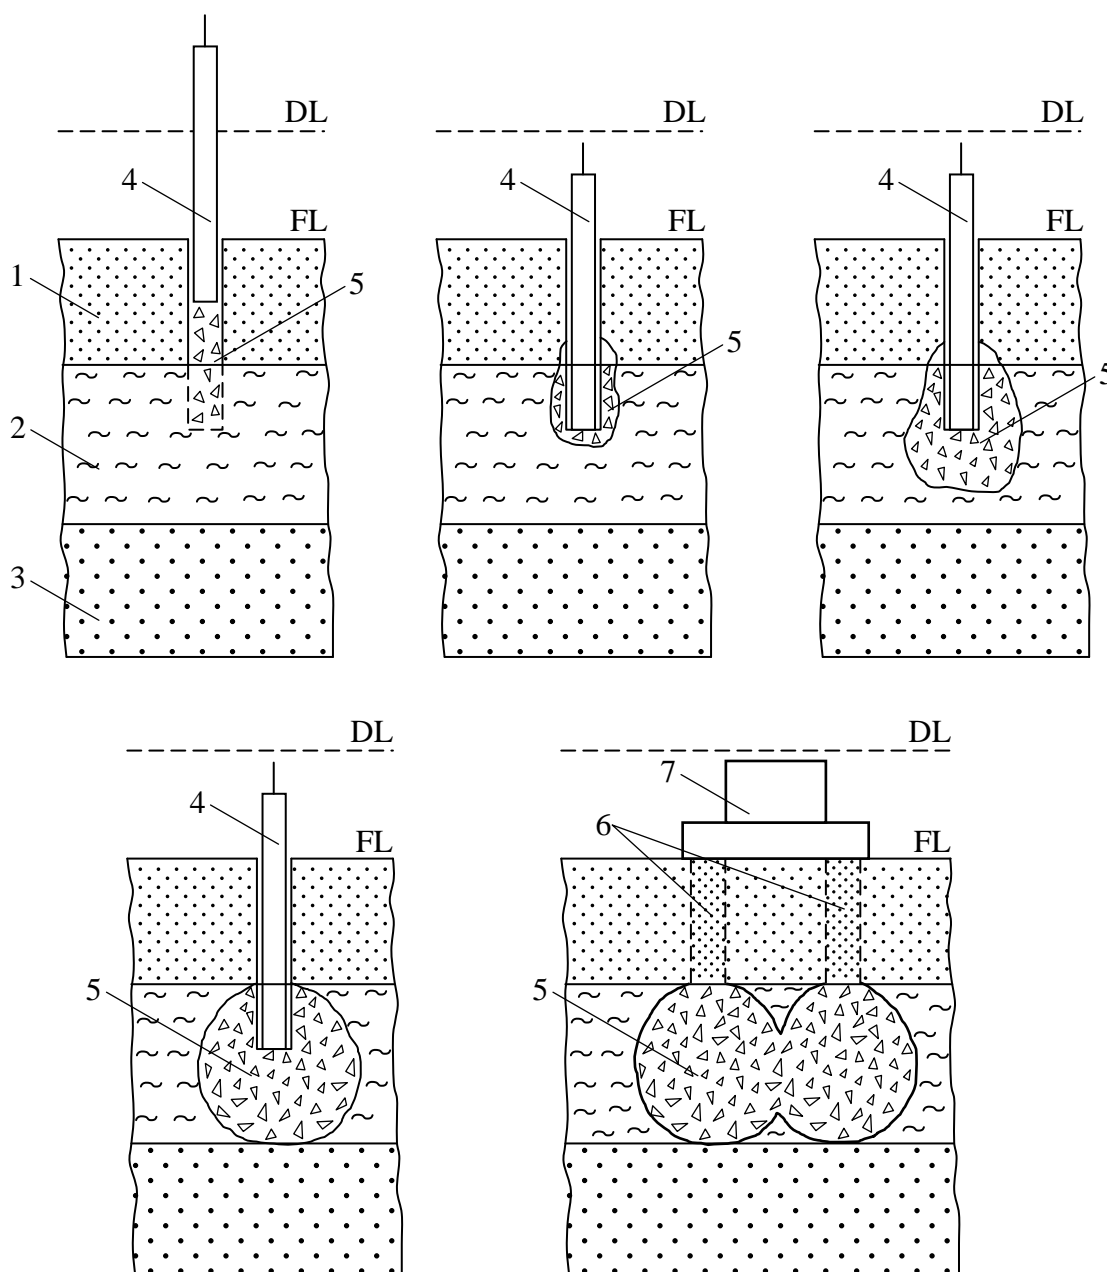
Послідовність улаштування фундаменту на слабкому підстильному шарі, який укріплено втрамбовуванням щебеню (пробивання свердловини, стадії втрамбовування щебеню, влаштування фундаменту мілкого закладання):
